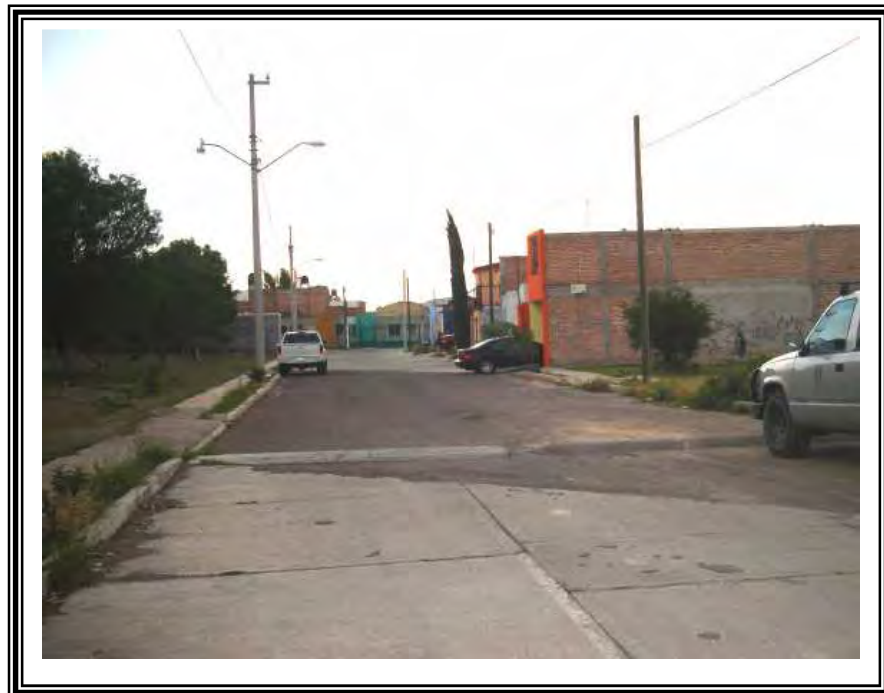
Banqueta de la calle Olmo que ha sido afectada por la falla.
